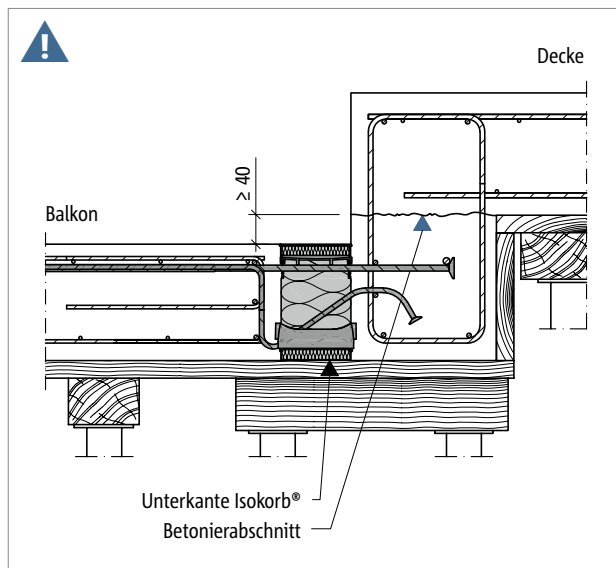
Schöck Isokorb® XT Typ KL-U: Ortbetonbalkon mit Höhenversatz nach unten
